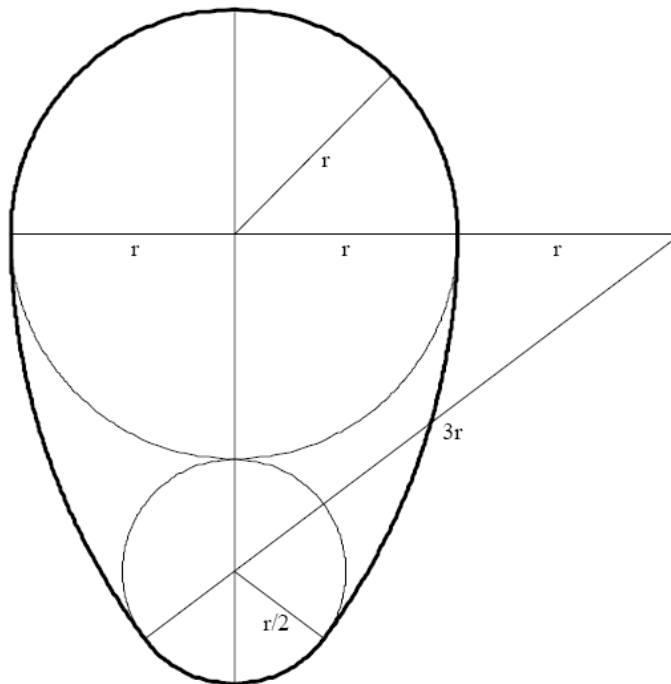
Costruzione geometrica di uno speco ovoidale vecchio inglese
